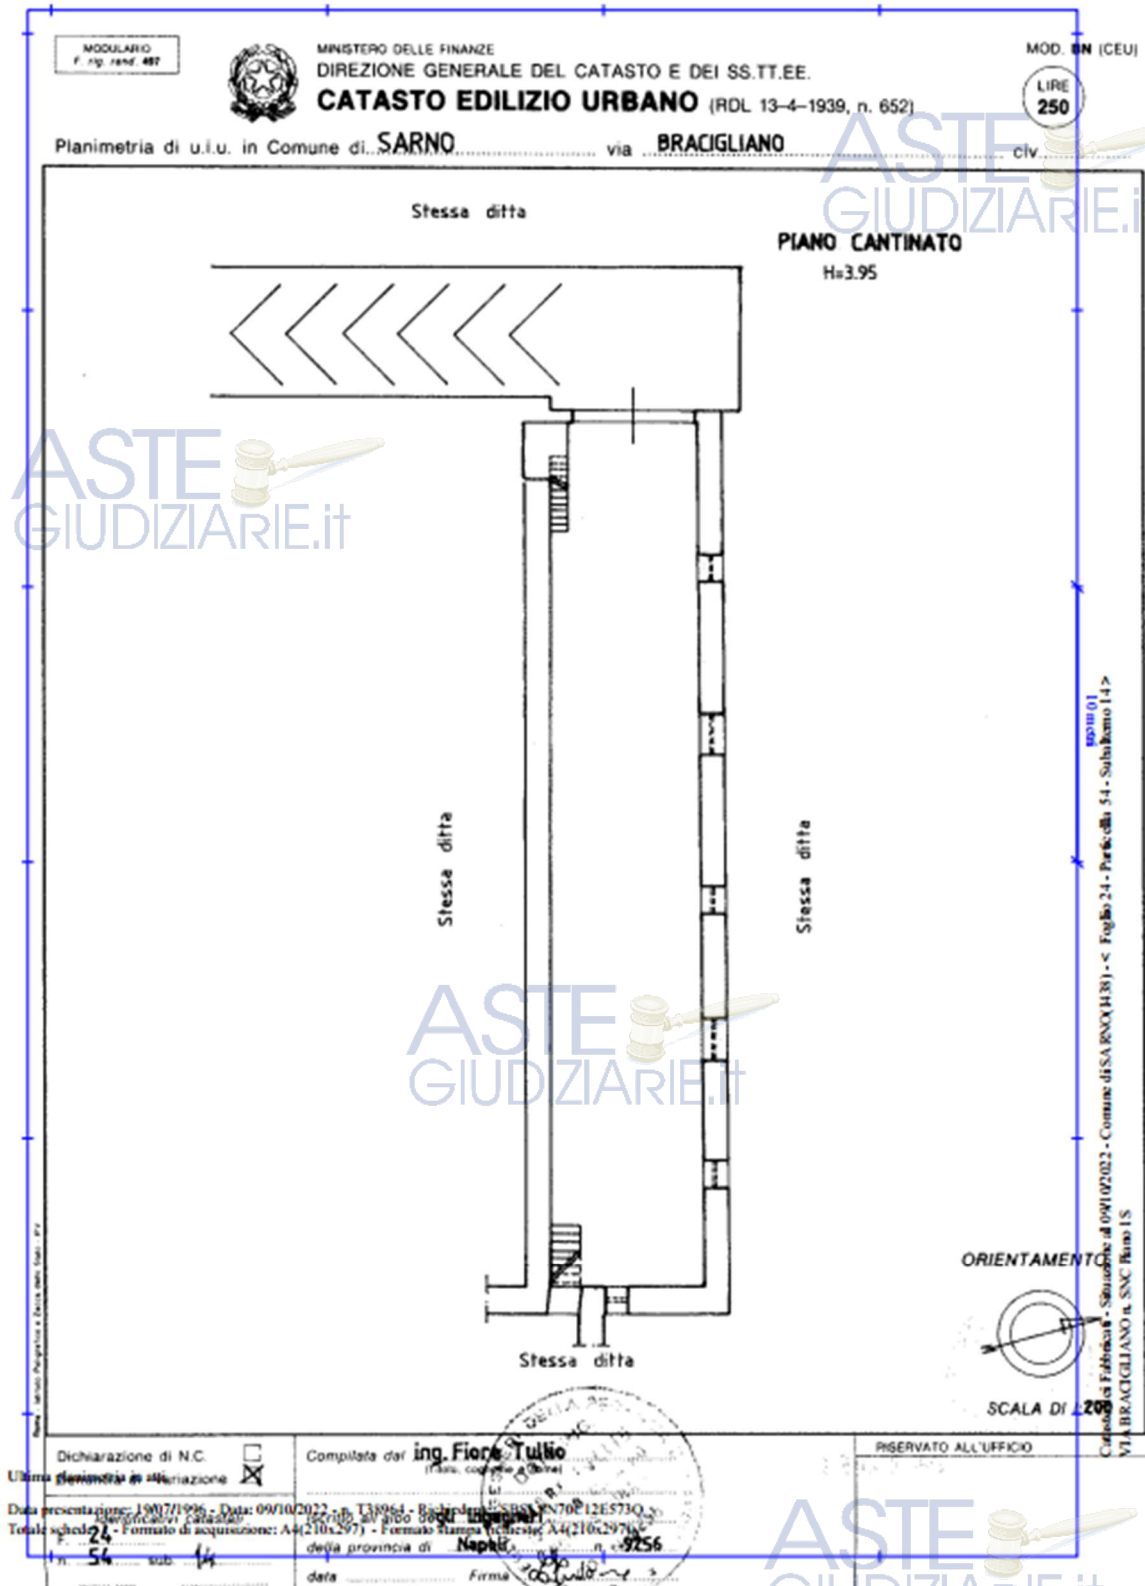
Planimetria catastale appartamento lotto 3 (F. 24 p.lla 54 sub 14)
